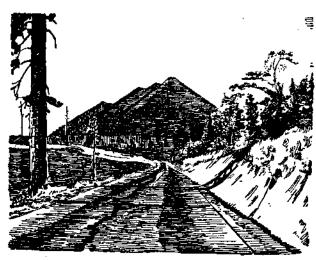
Бетонная дорога с продольной трещиной в САСШ.
